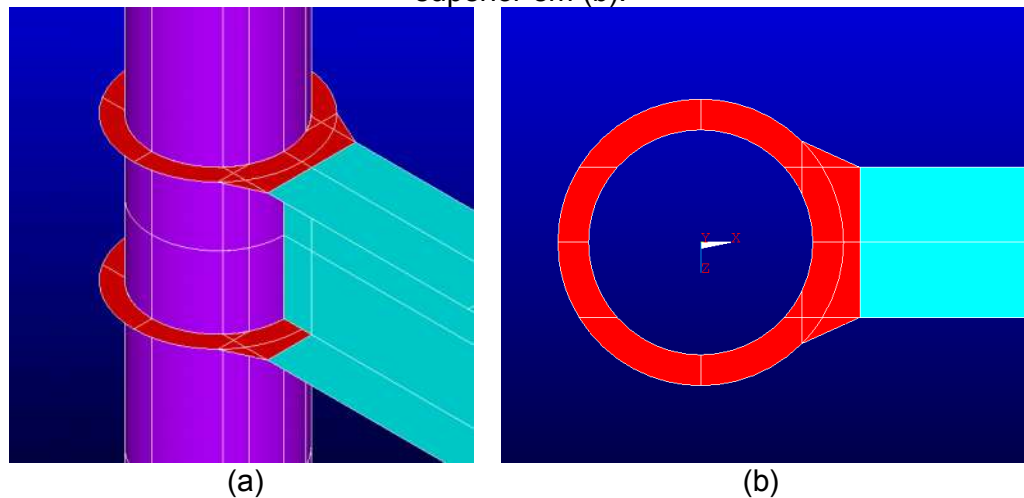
Ligação viga-pilar por meio de diafragma passante
